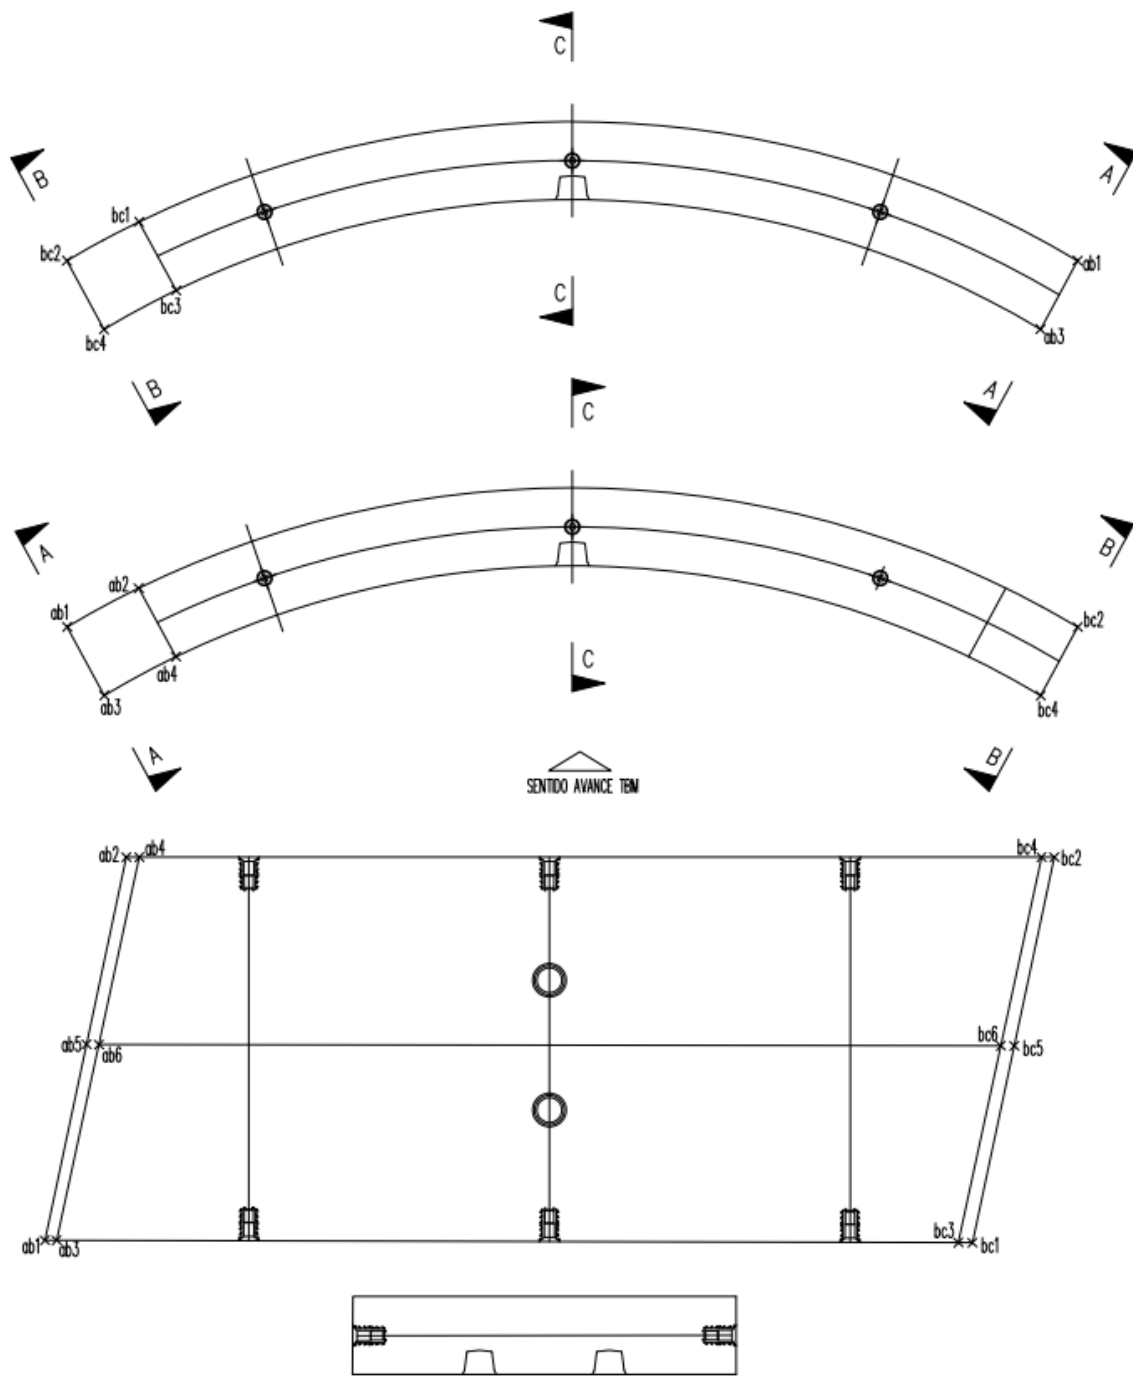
Plano esquemático de elementos en juntas en dovelas (conectores / barra de guiado).
